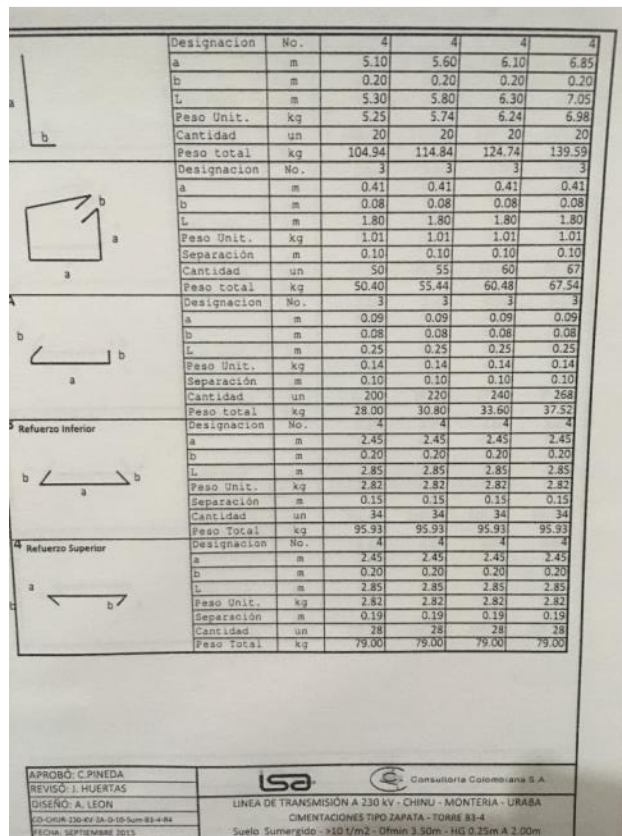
Plano estructural tipo de la torre 69 (2)
